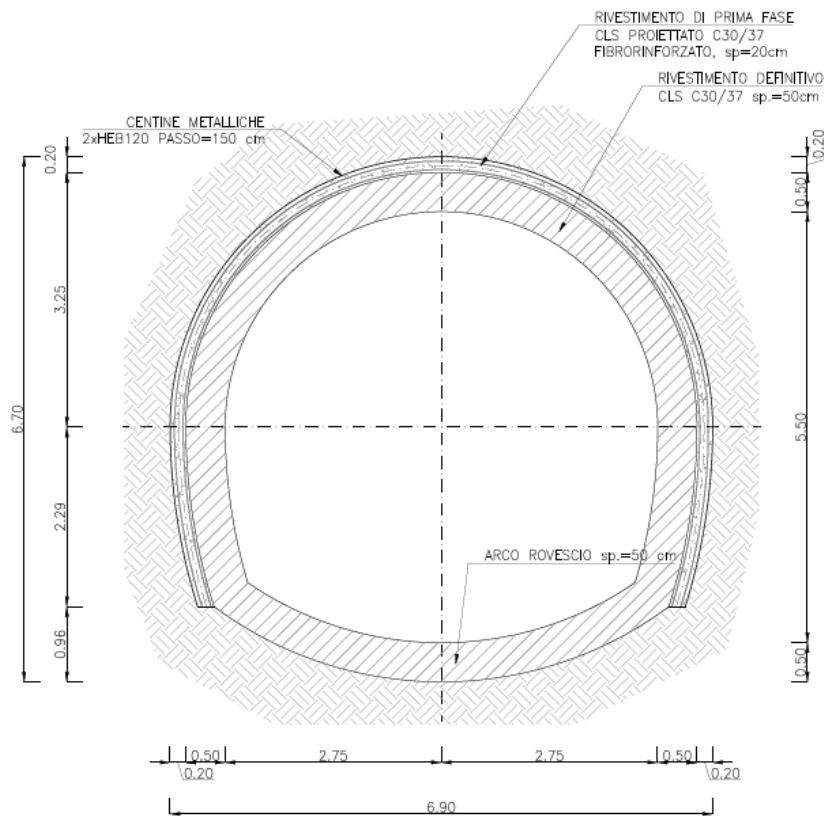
Sezione tipo GI-2: geometria del cavo e interventi di sostegno
